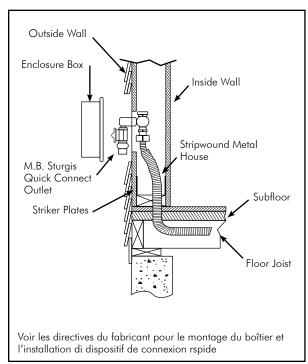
Branchement de barbecue avec un dispositif de connexion rapide
